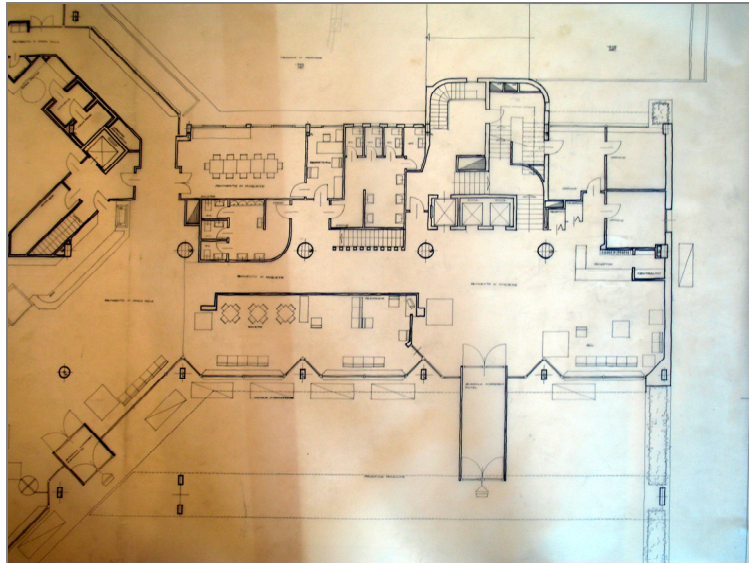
pianta piano terra corpo A (fonte CSAC – stralcio tav. 38, archivio n. 161-1)
